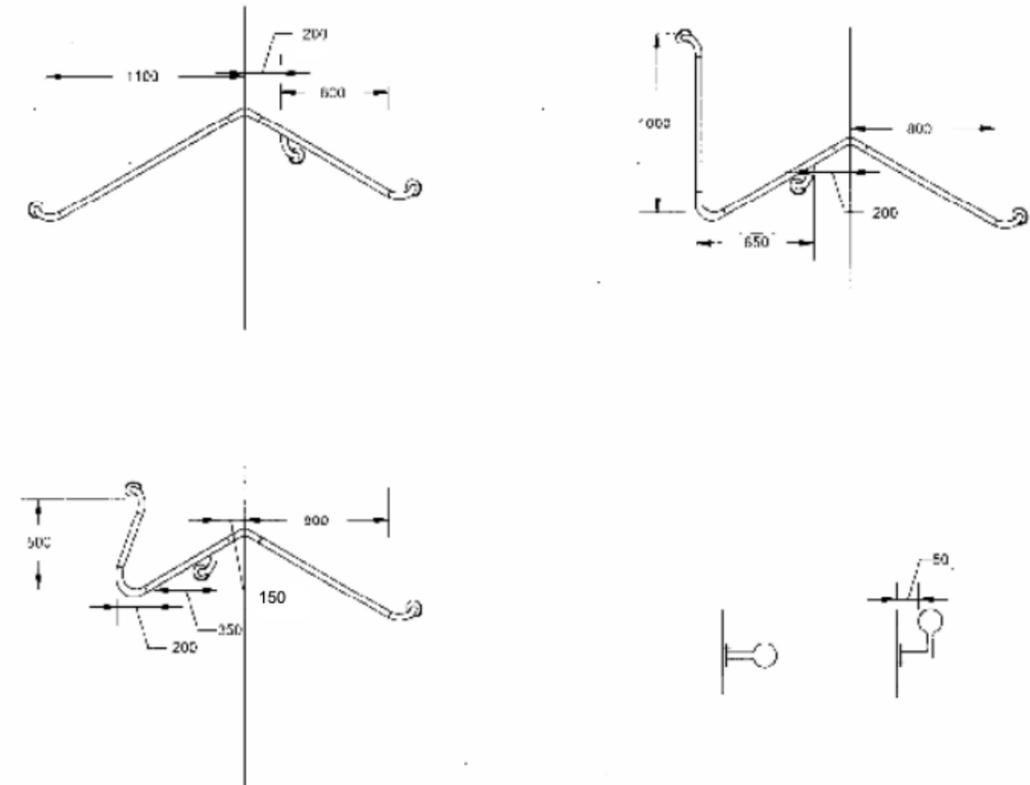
Barras de apoyo. Tipos. (Dimensiones en mm)
